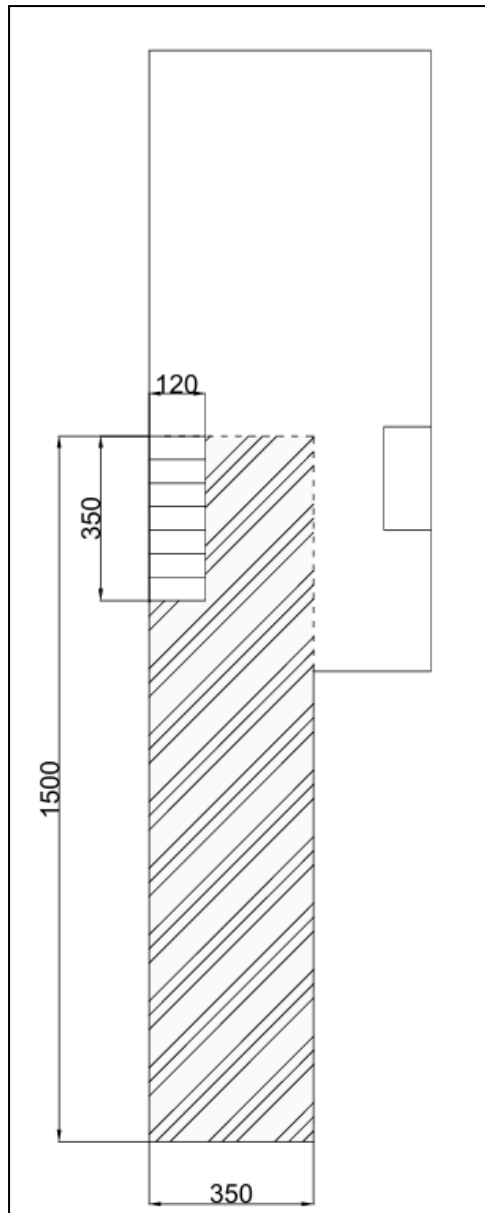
Plano de acceso del puente grúa dentro del depósito – Nave B [cm]
